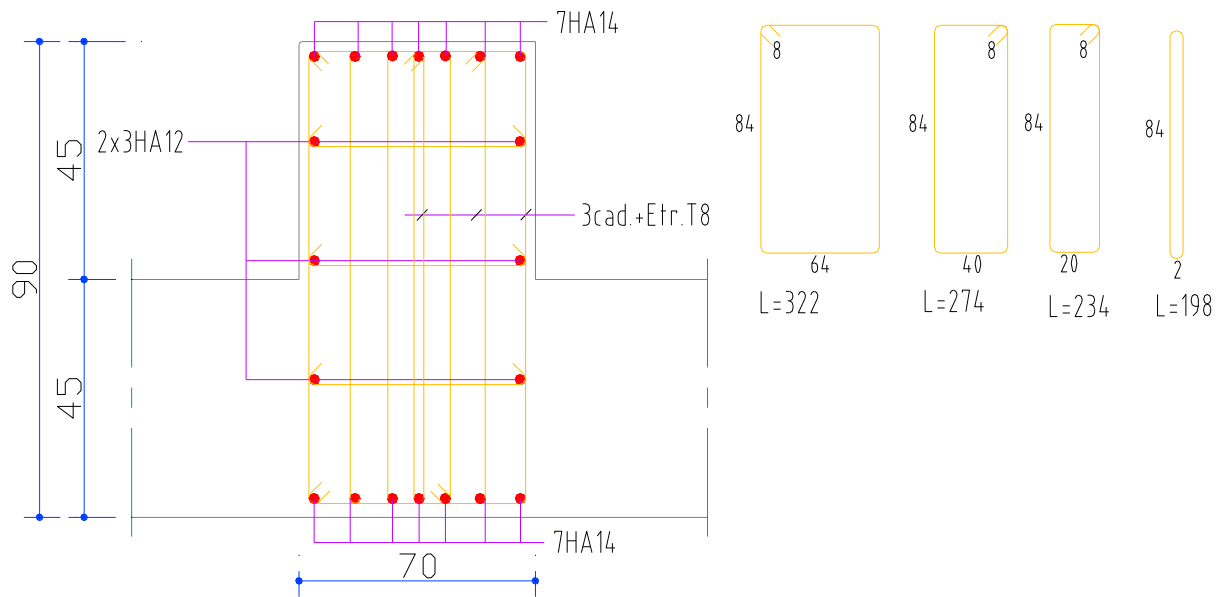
Coupe de ferrailage des nervures secondaires au niveau travée.
